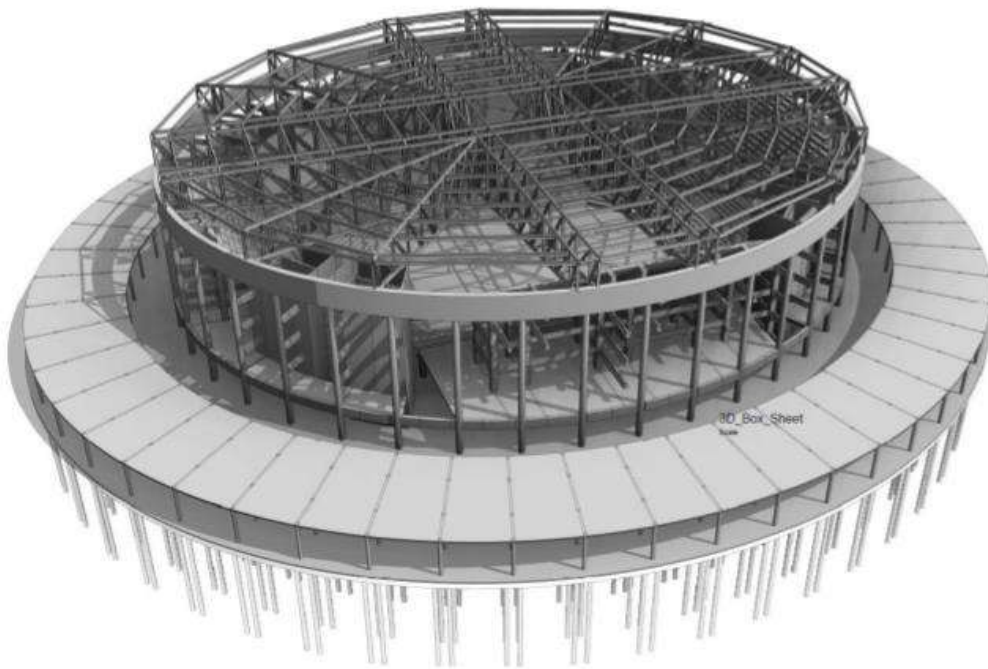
ASSONOMETRIA DELLE STRUTTURE
